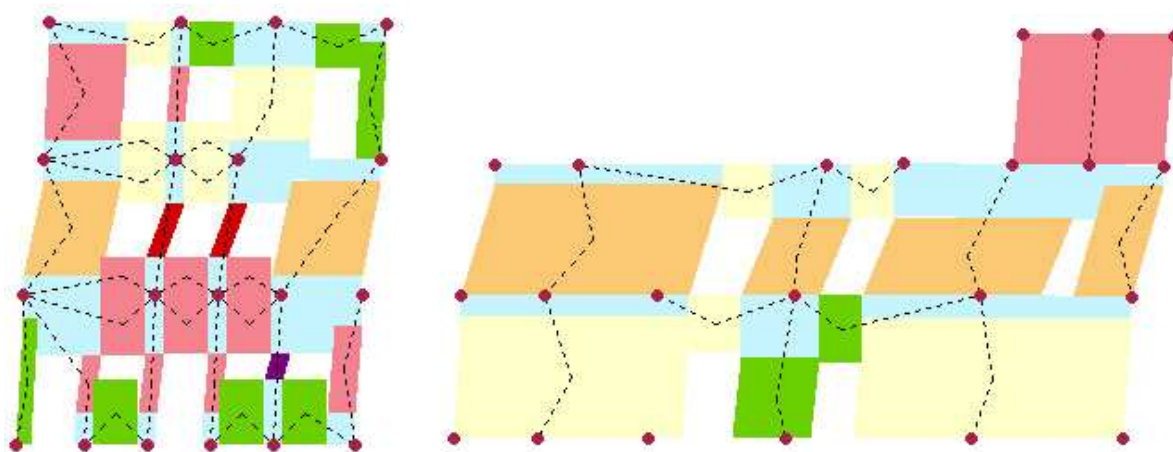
SISMA Y – Meccanismo di rottura dei maschi murari a taglio (arancio) e pressoflessione (rosso) al primo piano. Formazione del meccanismo di piano soffice (pareti 7 e 10) e decadimento del taglio alla base con collasso della struttura.
